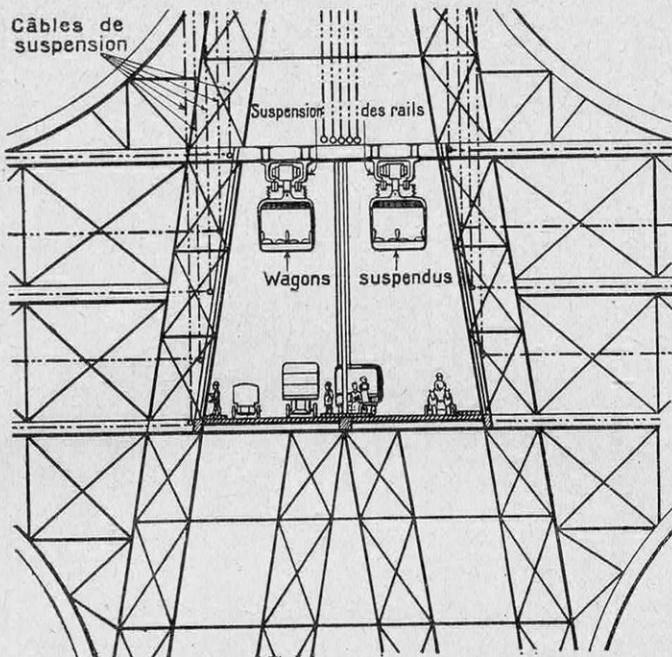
SECTION TRANSVERSALE DU PONT AU DROIT D'UN PYLONE. ÉCHELLE : 1/400^e
